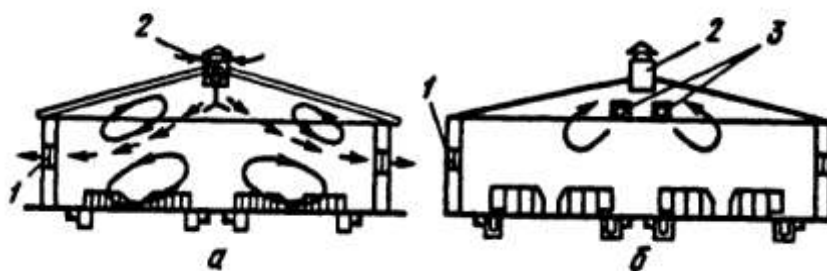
Вентиляция животноводческих помещений по схеме с избыточным давлением и вентиляторами, расположенными на крыше: а - теплый период года; б - холодный период; 1 - оконные проемы; 2 - вытяжные шахты; 3 - приточный воздуховод
